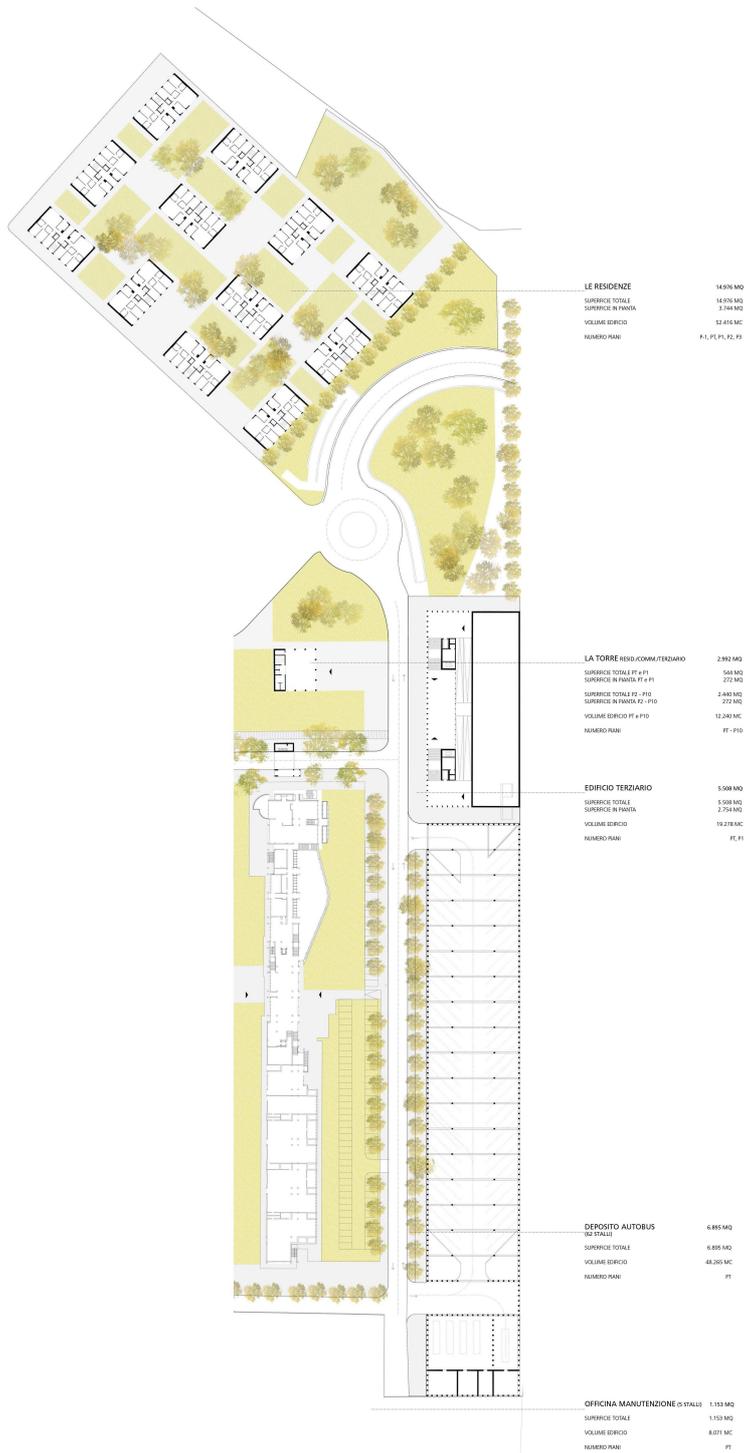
Planimetria via Zeni e nuova area residenziale
